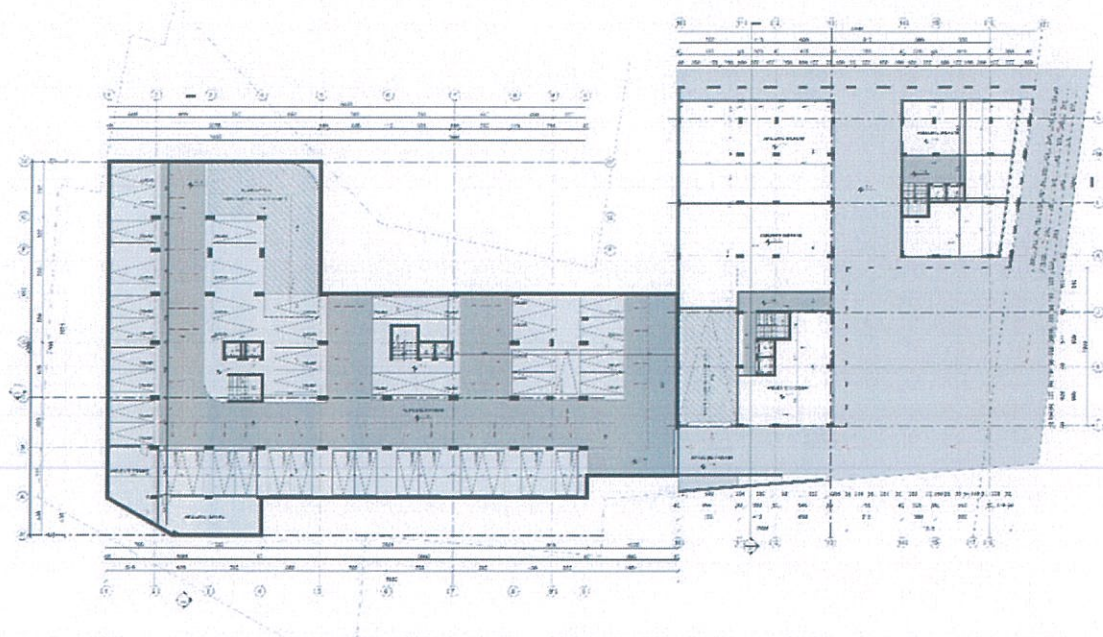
Plani i katit -2 3002.4 m² (parkime dhe sherbim)
